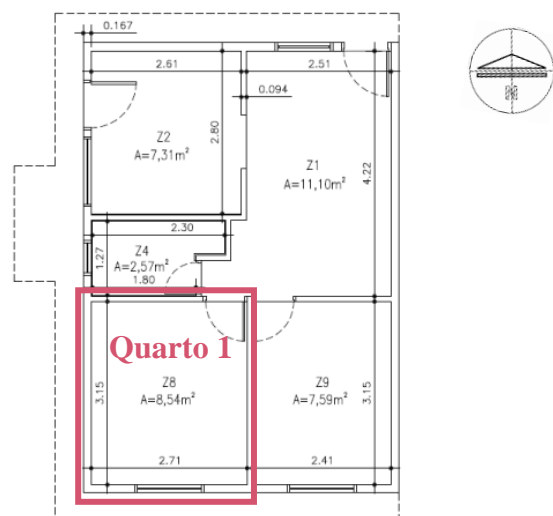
Planta da habitação. Fonte: Adaptado de Marques (2013)
